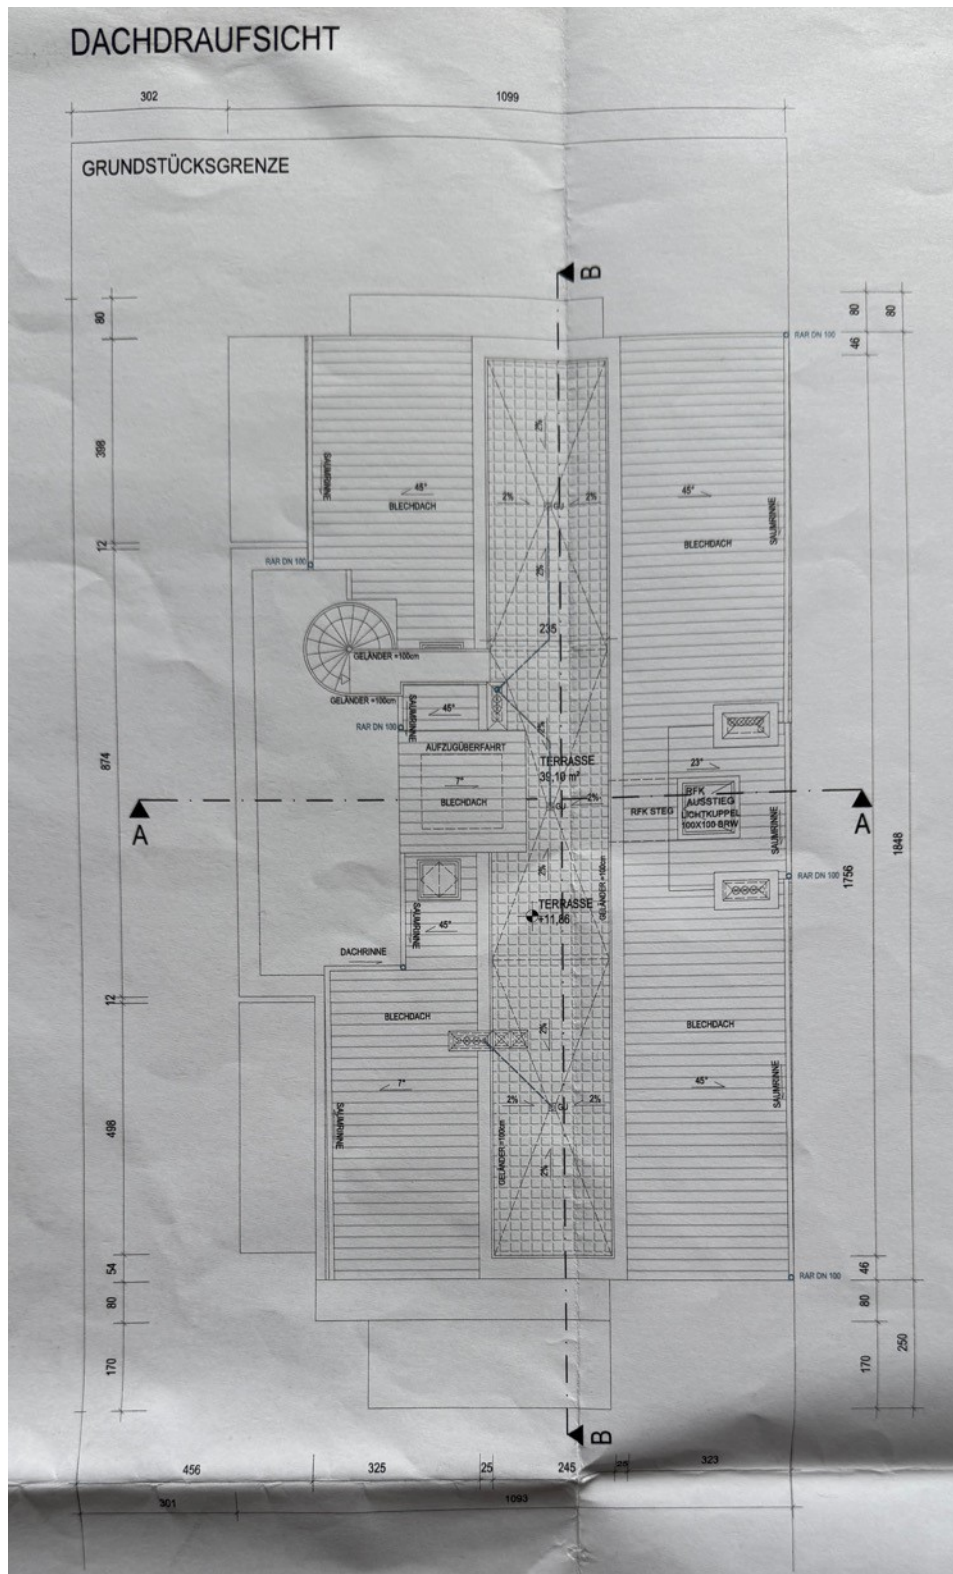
Einreichplan – Dachdraufsicht / Quelle: auftraggebende Partei
